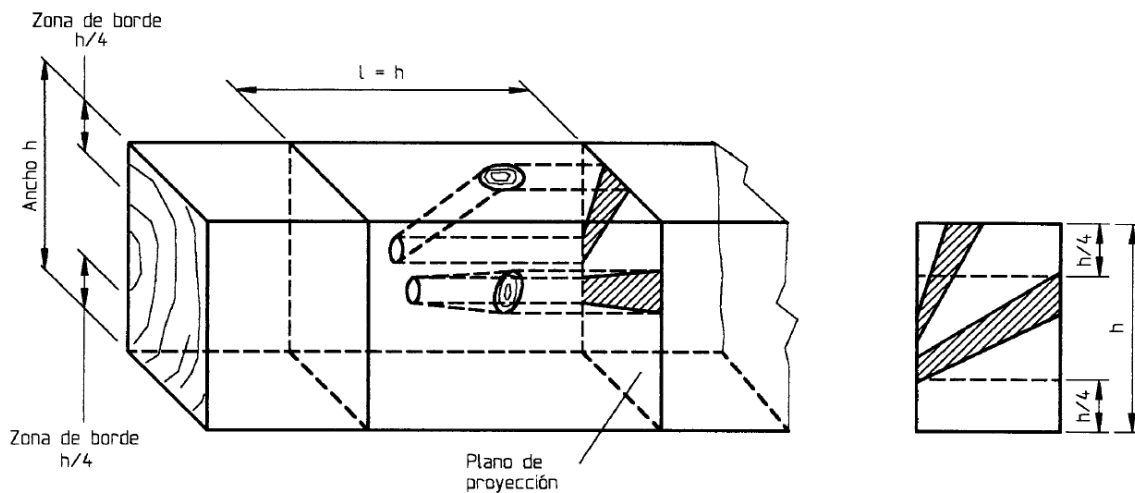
Proyección de nudos en la sección transversal de la pieza (Nch 1207 of.2005)
